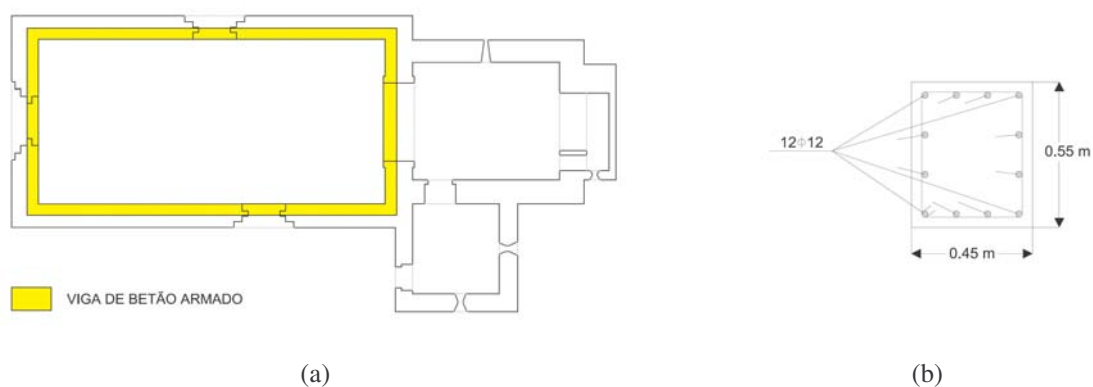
Modelo MSV-A4. (a) Posicionamento da viga de coroamento em betão armado na igreja de Gondar. (b) Características da viga de betão armado.
